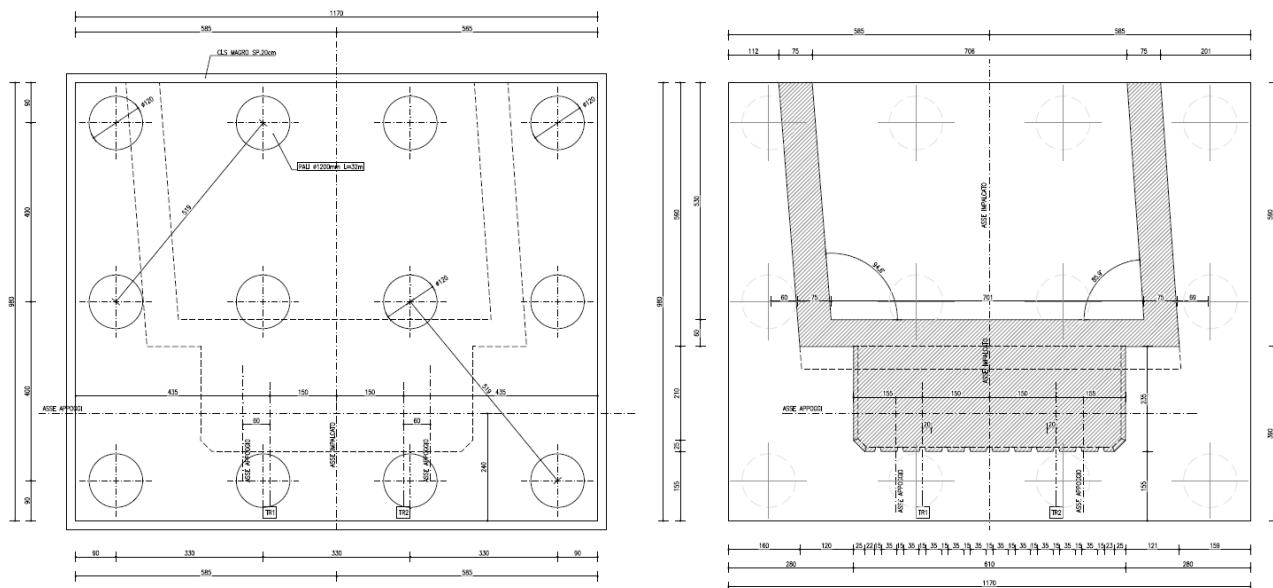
Spalla 1 – carpenteria fondazioni
